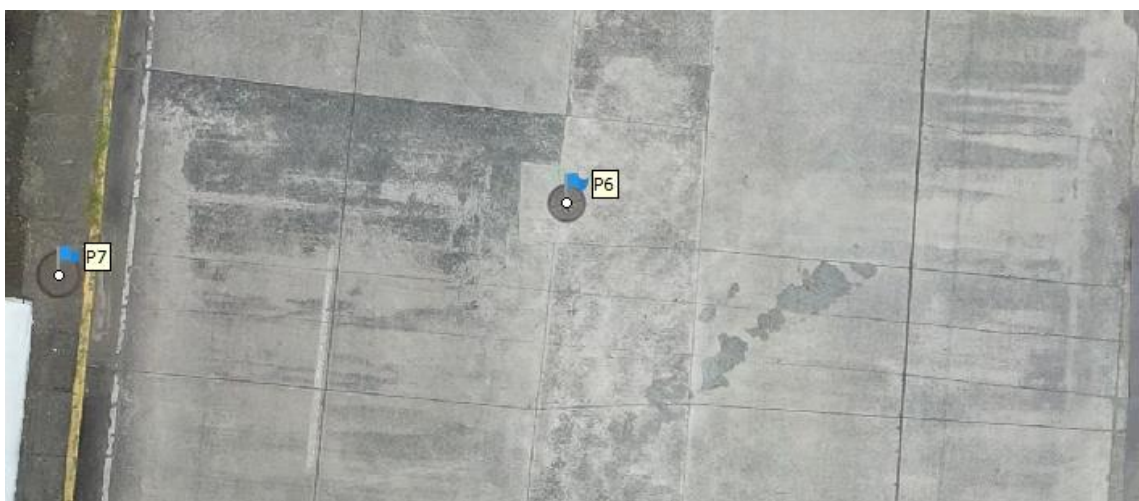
Puntos de Apoyo #P6 #P7 Tapas de Alcantarilla y Drenaje (Agisoft Metashape)
